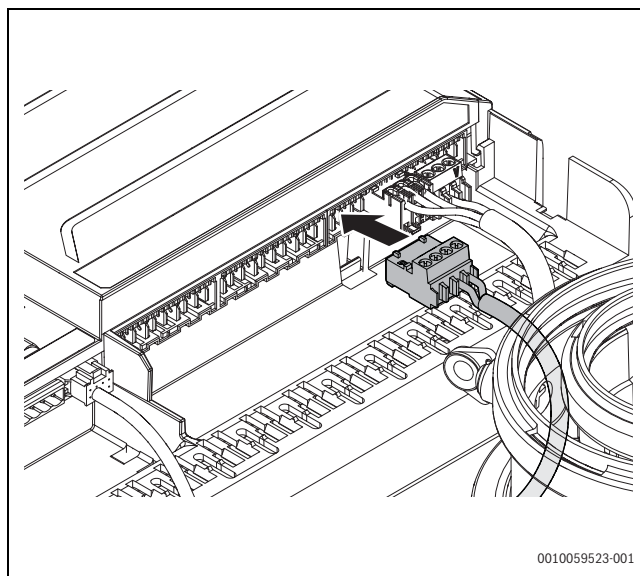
Stecker von der Kesselsicherheitsgruppe einstecken
